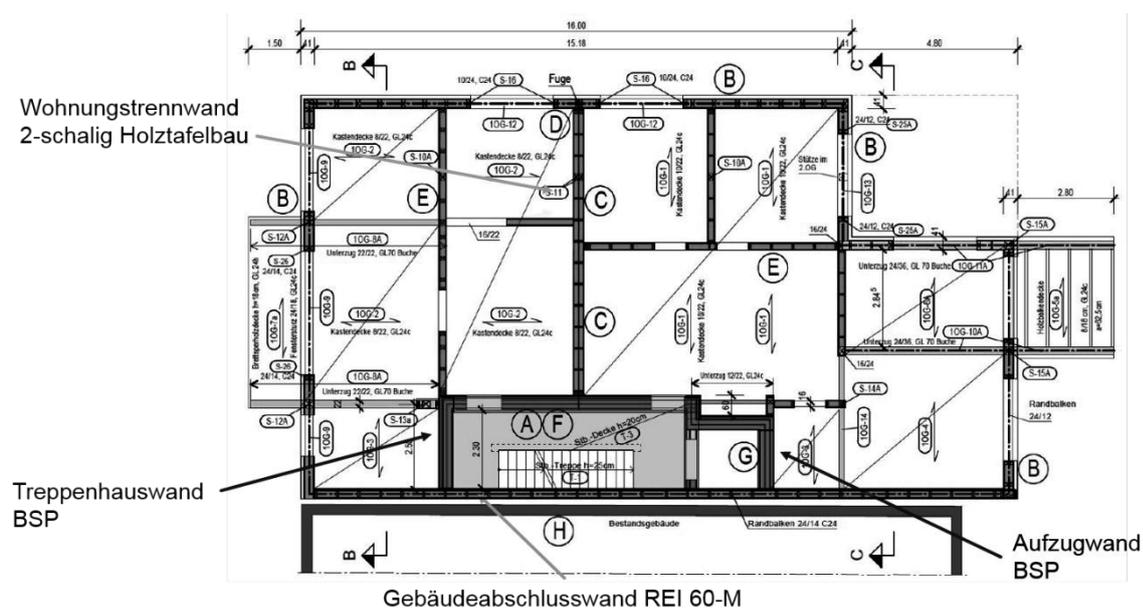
Grundriss Weyertal [Seibel Architektur Consult]
